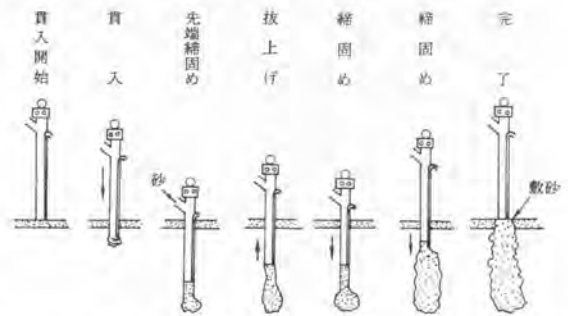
パイプロ方式によるサンドコンパクションパイル工法施工順序
